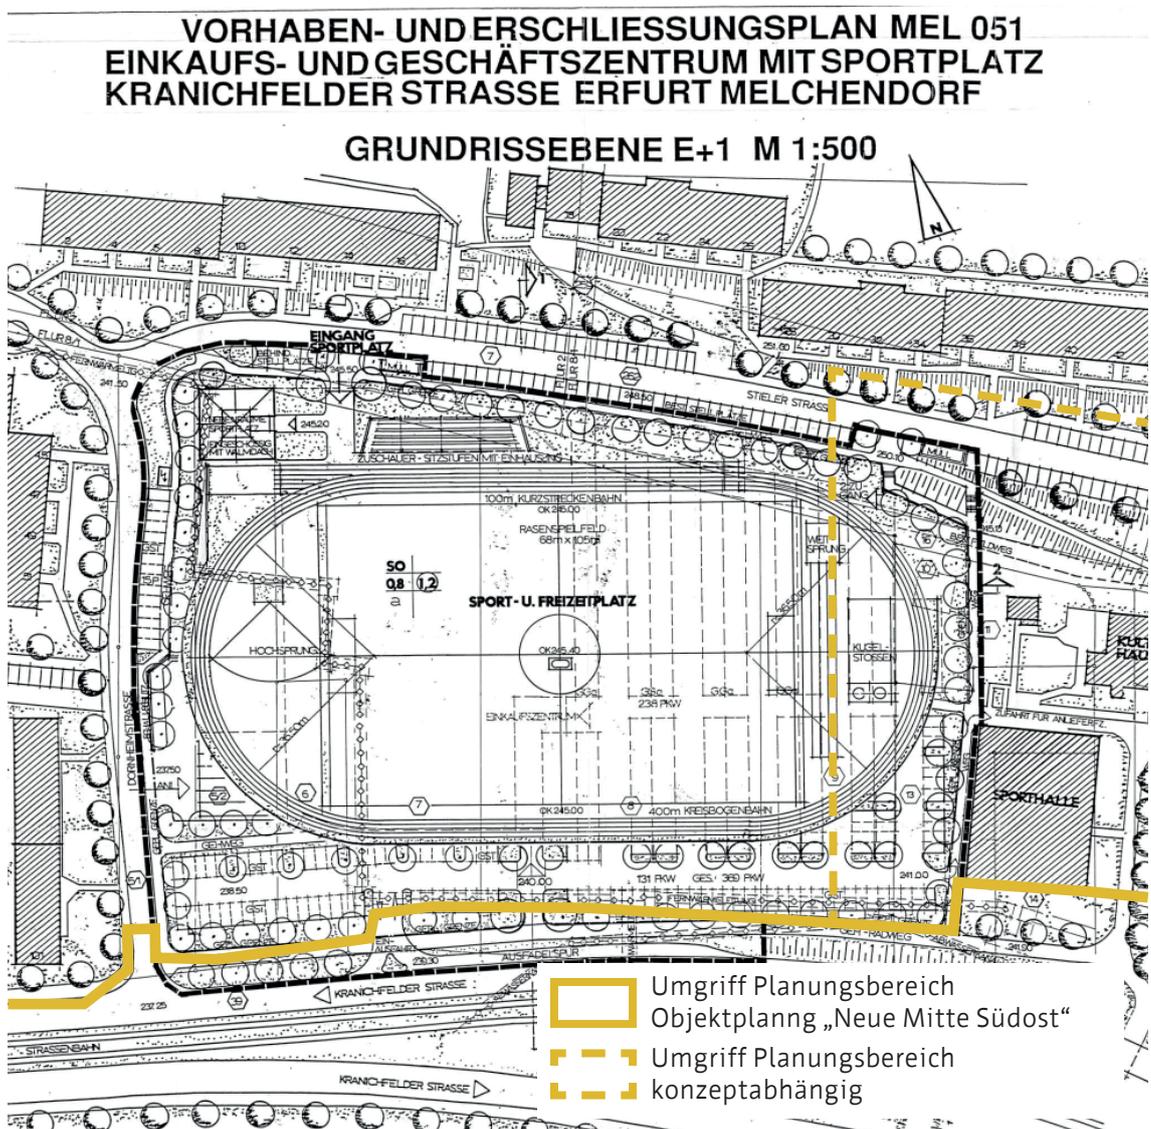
Auszug Vorhaben- und Erschließungsplan MEL 051 mit Überlagerung Planungsbereich Objektplanung, LH Erfurt
